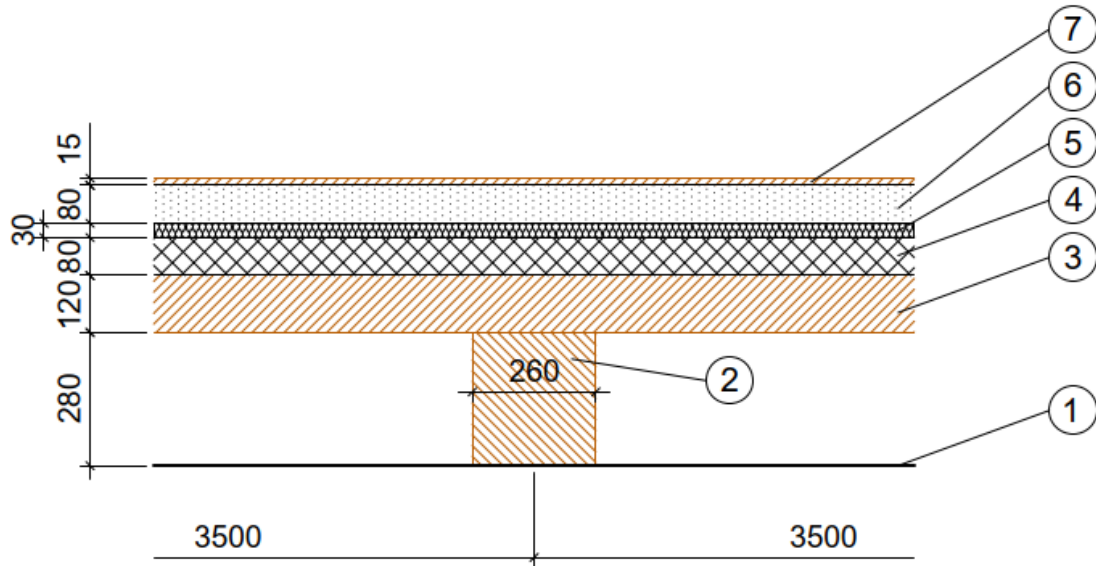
Aufbau Holz-Beton-Verbunddecke (Brettstapel)
